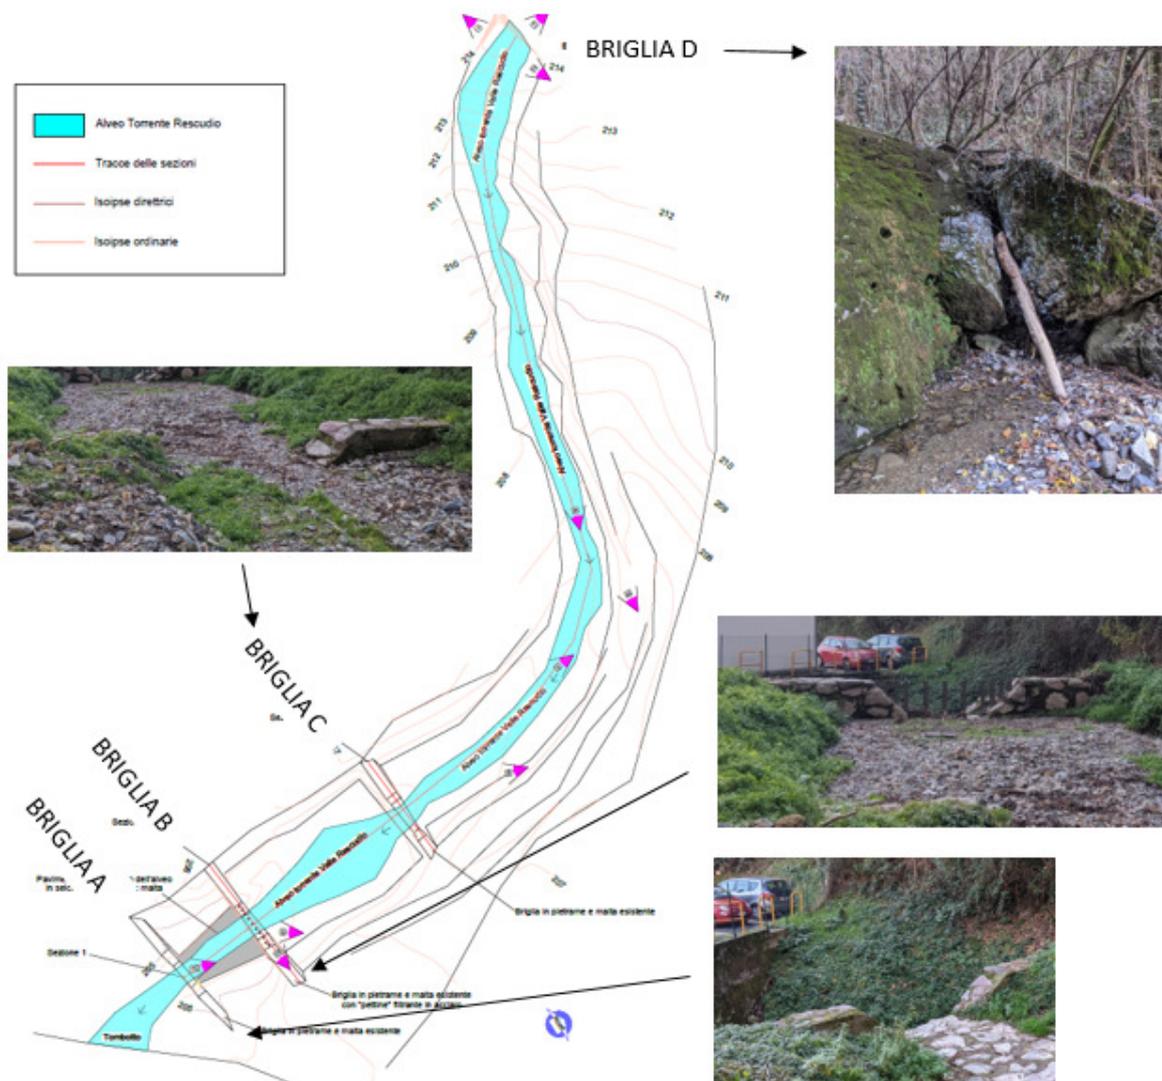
Stralcio della Tavola C.2 – Planimetria dello stato di fatto.
